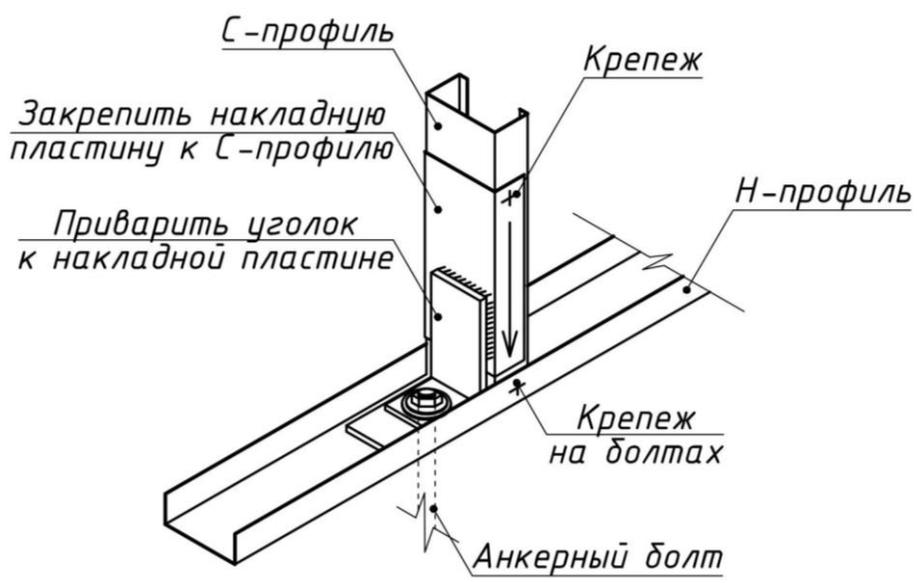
Узел НС 5. Крепление стойки стены к фундаменту
